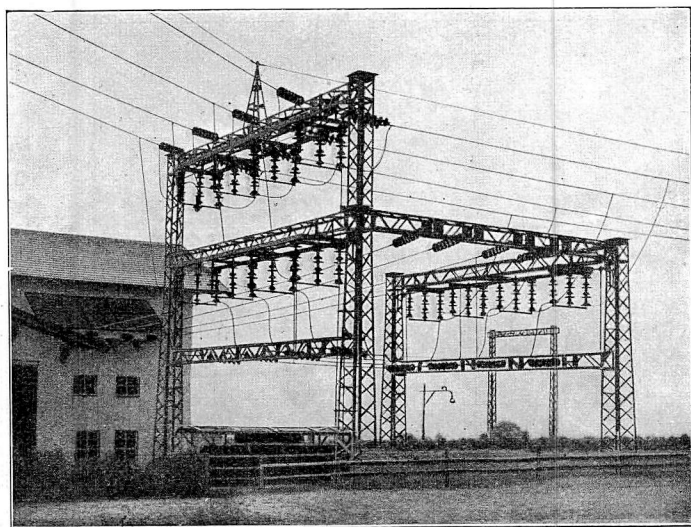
Anzapfung der Leitungsstraße Walchenseewerk—Pasing mit Freiluft-Trennschalter vor Unterwerk Murnau.
